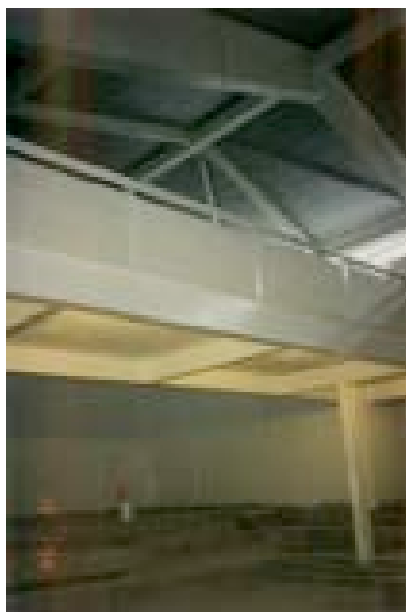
SX, le travi di copertura dipinte – (AABS-1998_01_19 - Foto Santa Rosa_15)
